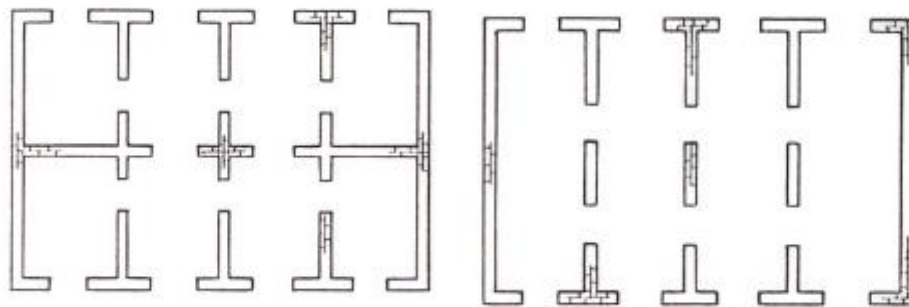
Muret mbajtëse në dy drejtimet adekuate dhe Muret mbajtëse në një drejtim joadekuateq
